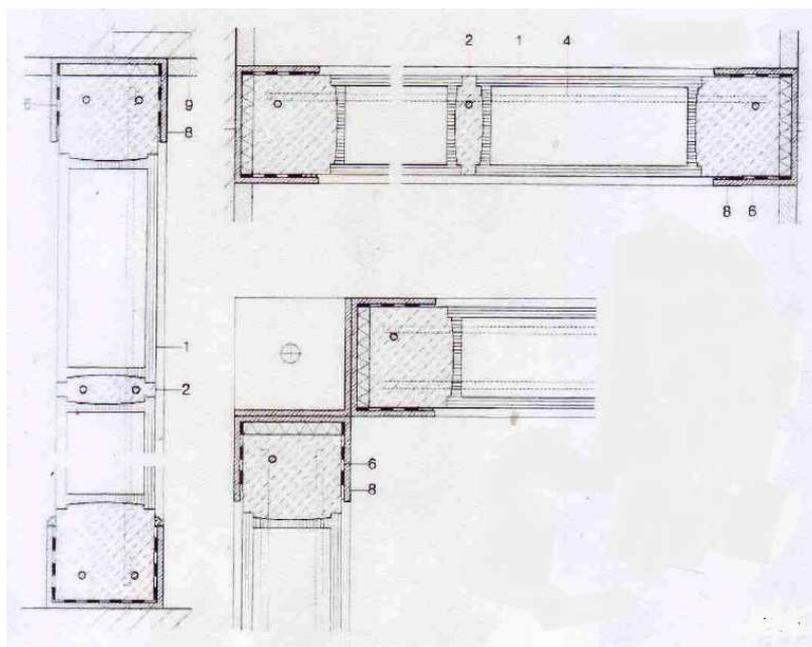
Muratura di vetrocimento con correlazione in profilo a U
